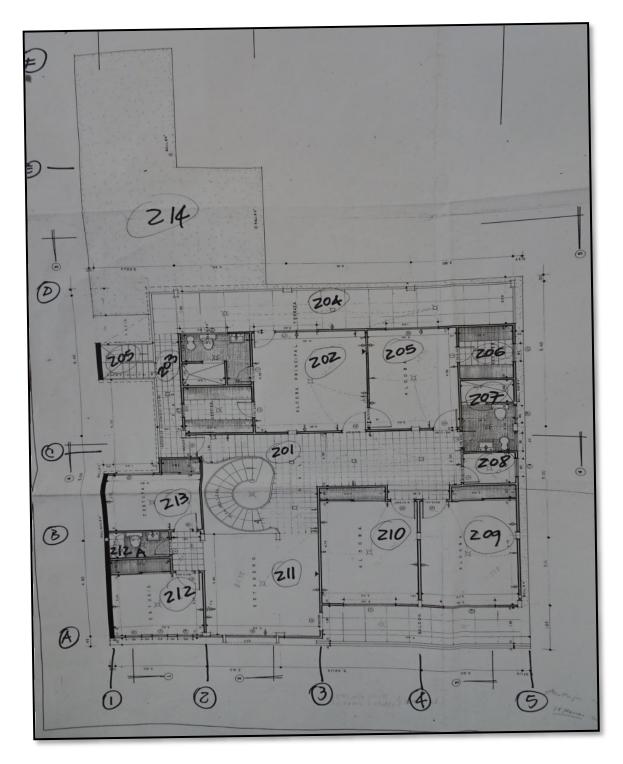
PLANO ARQUITECTÓNICO - PISO 2
